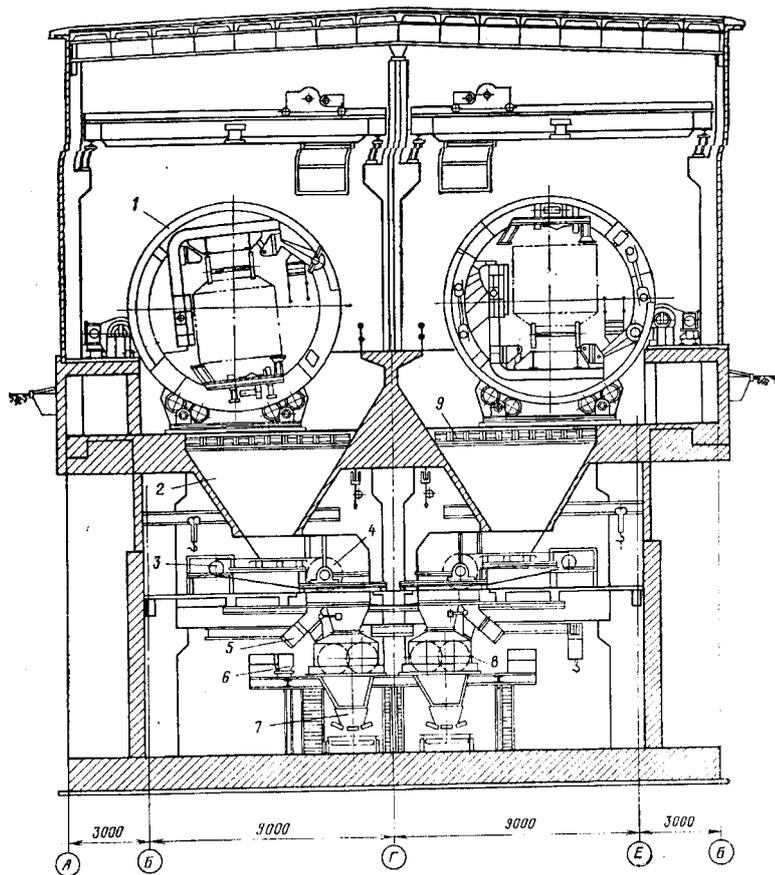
Разгрузочное устройство с двумя роторными вагонопрокидывателями.
